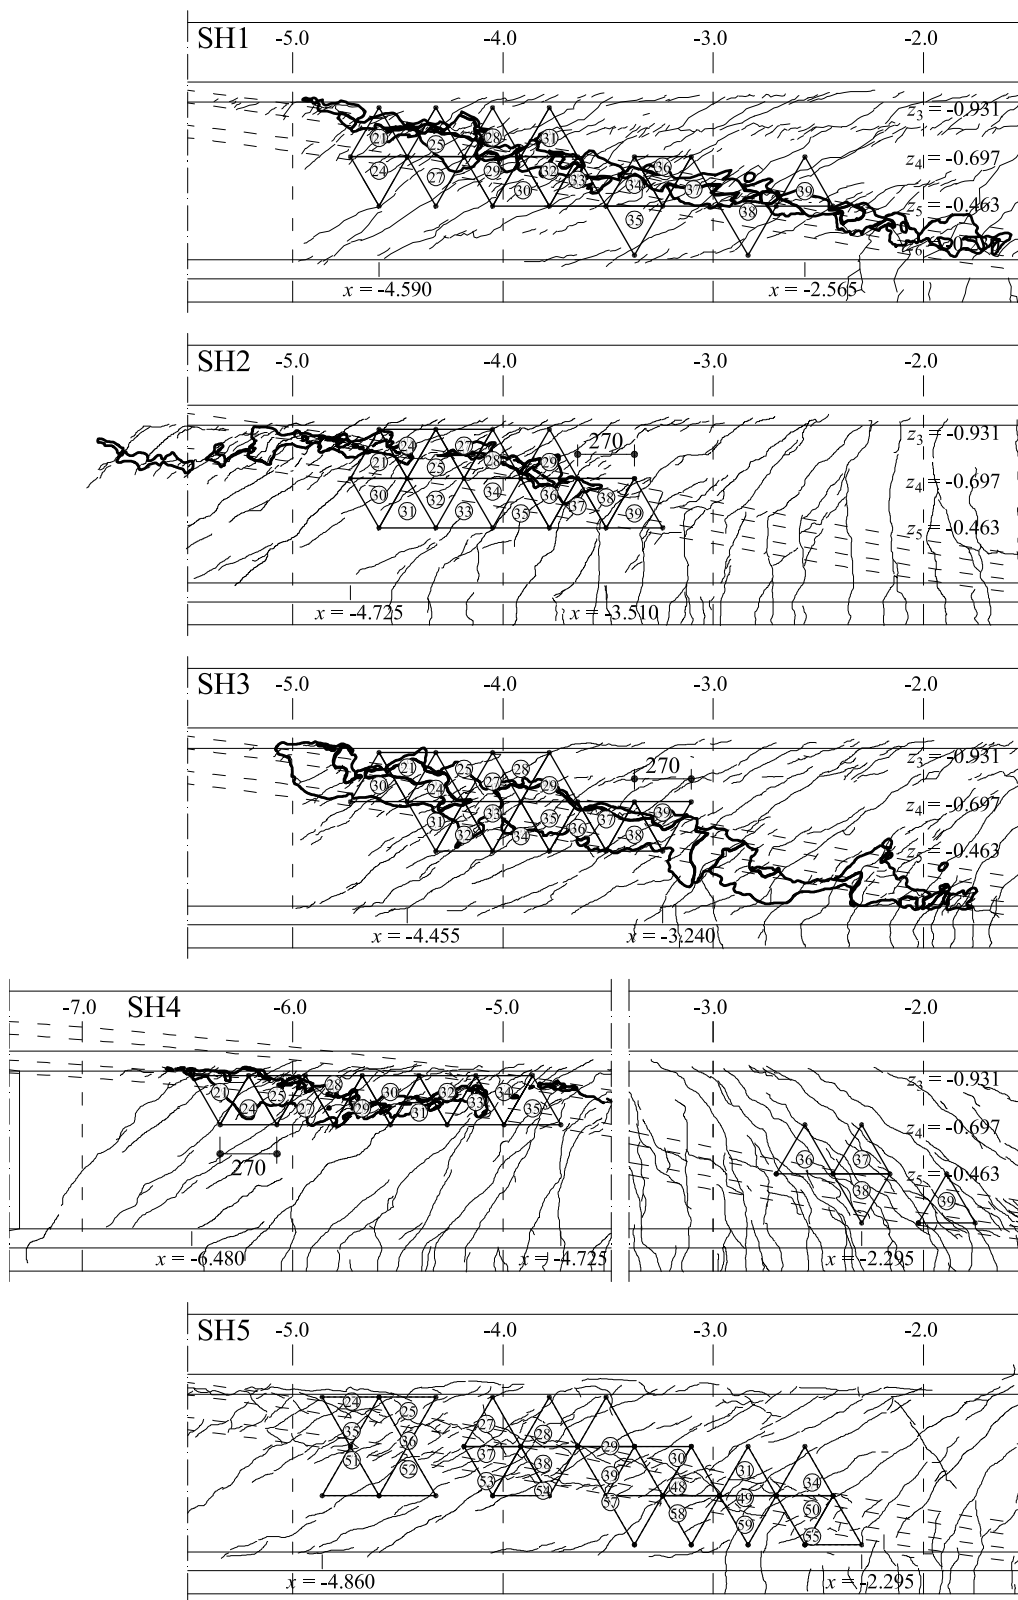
Poutres SH1 à SH5, partie Nord : fissuration et éclatement du béton lors de la rupture ; emplacement des capteurs dans la zone susceptible de rupture mesurant l'allongement local du béton de l'âme et la fissuration interne dans le plan de l'âme
